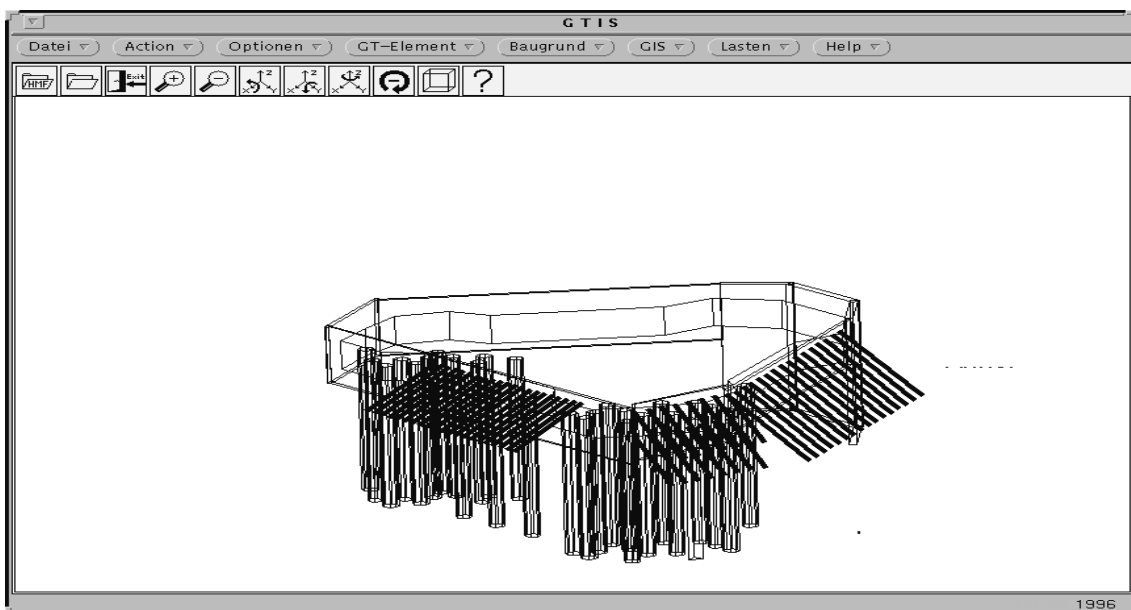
Geotechnisches Konstruktionsmodell des neuen Commerzbank-Hochhauses
